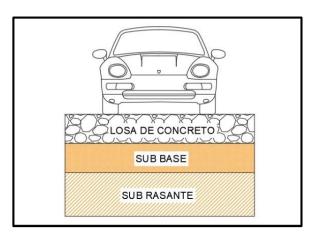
Capas de un pavimento rígido Fuente: Elaboración propia
